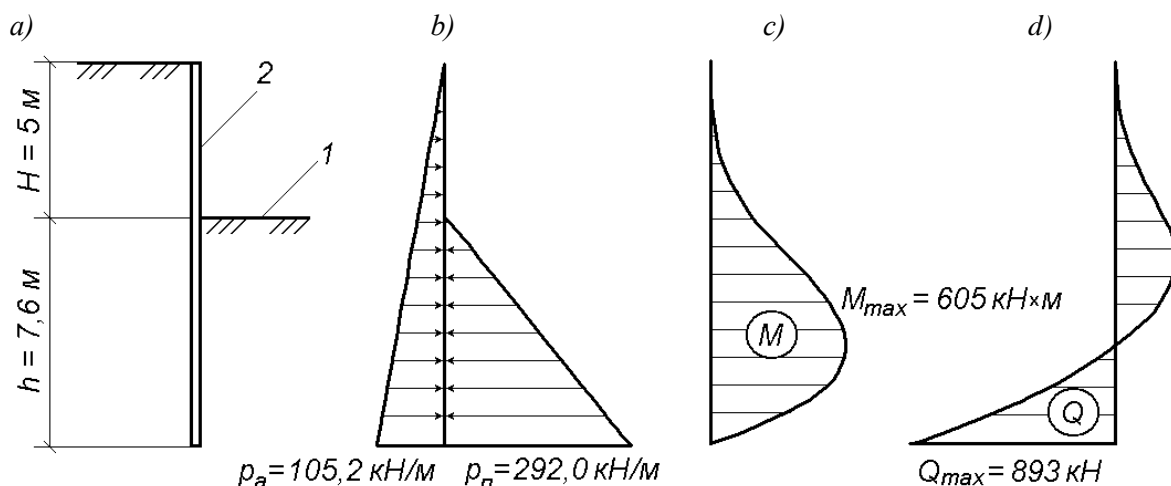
Крепление стенок котлована шпунтовым свайным рядом без анкеровки:
